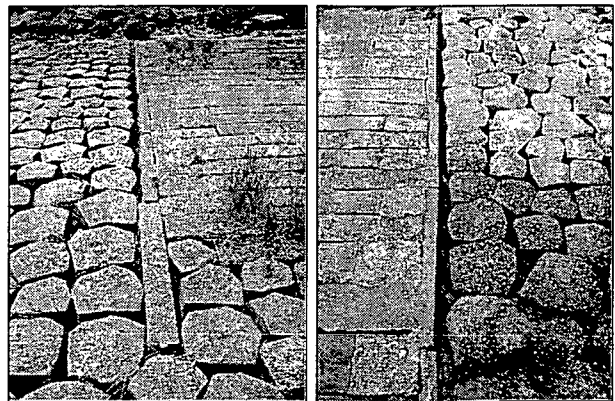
en 2b: overgangsconstructie met afgeschuinde betonbanden
